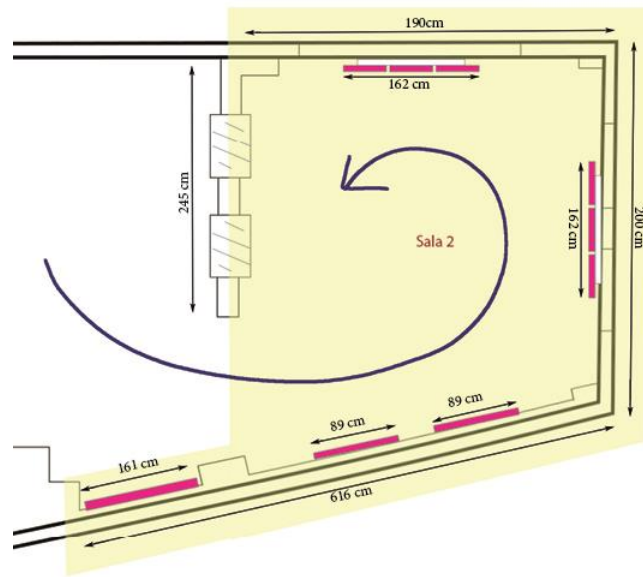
Plano de planta y disposiciones. Sandra Bosch.
